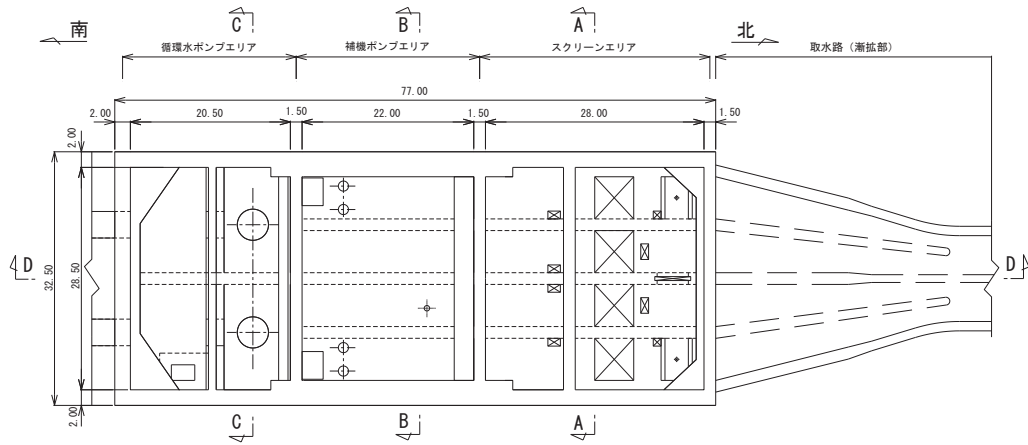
(1) 海水ポンプ室 概要図 (平面図)
